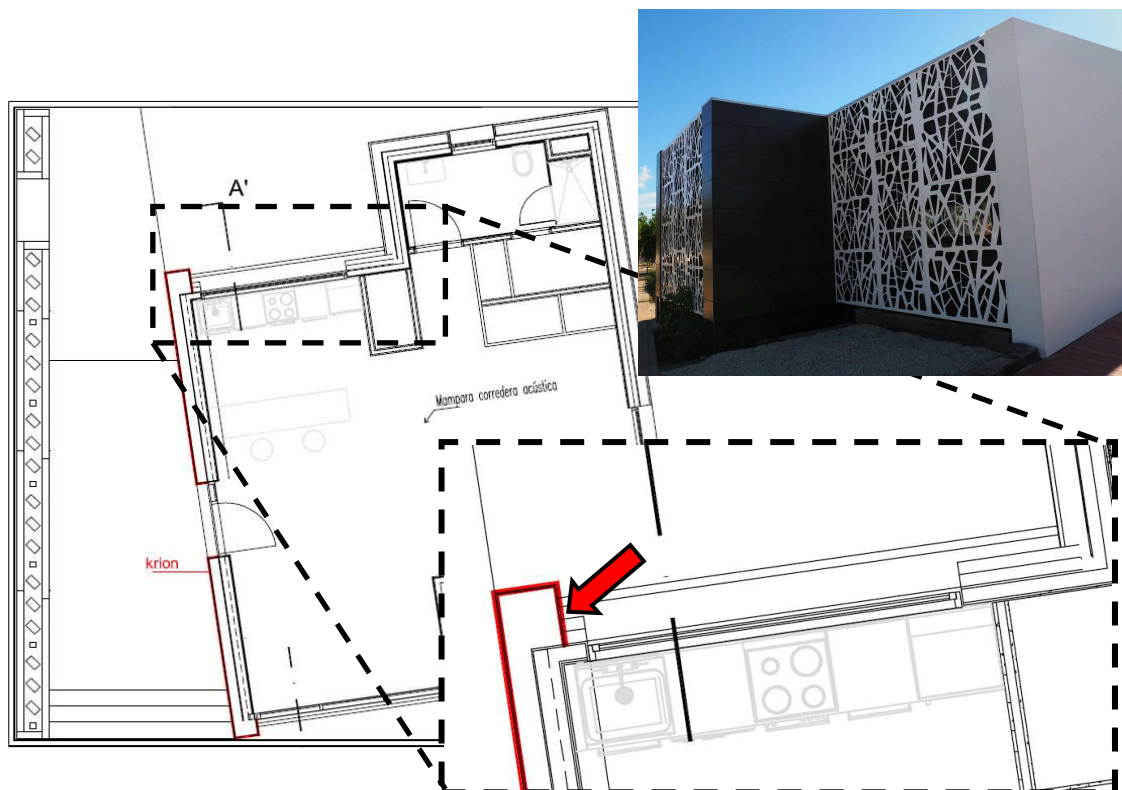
Prolongación del testero de la fachada de krypton para albergar la celosía de la fachada norte / [EP]
